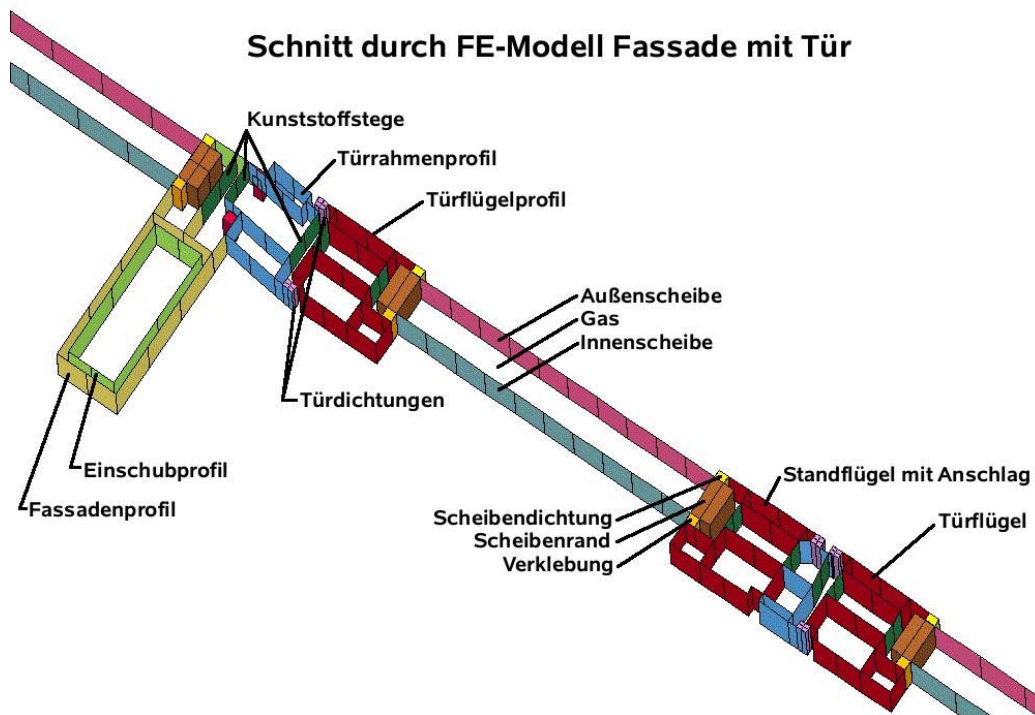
Schnitt durch Fassade mit Profilen und Isolierglasscheibe (FE-Modell)
